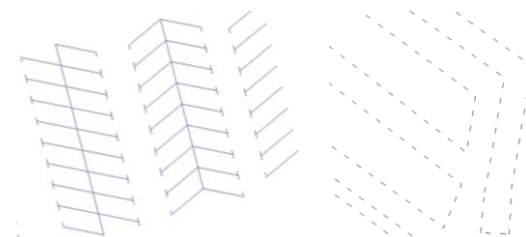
Ejemplo de aparcamientos en batería y en paralelo
